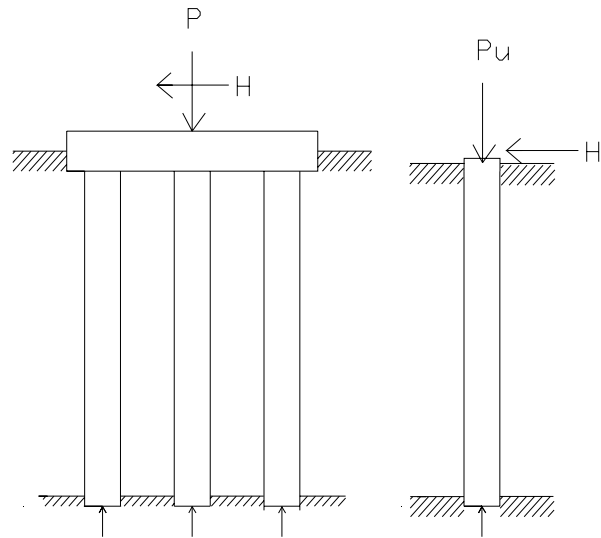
Pondasi dalam ($D/B \geq 4$)
